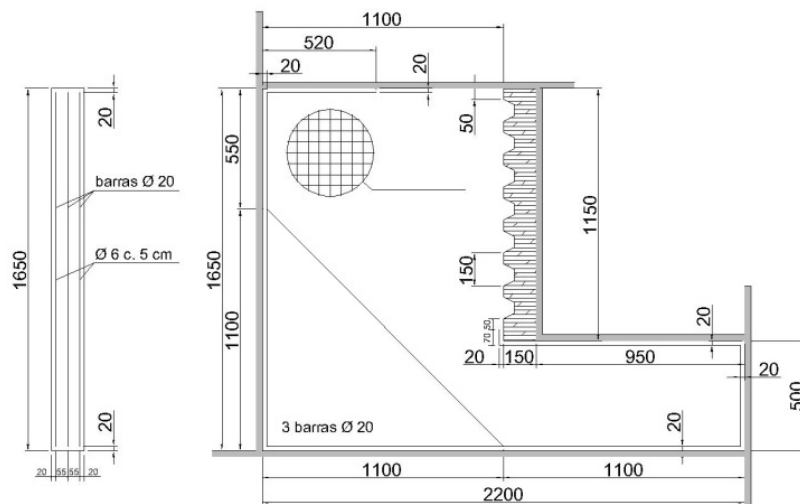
Disposición de las barras y mallas electrosoldadas para la fabricación de las piezas de hormigón en el perfil (izquierda) y encofrado para la primera pieza (derecha) para la junta de siete llaves (cotas en mm)
